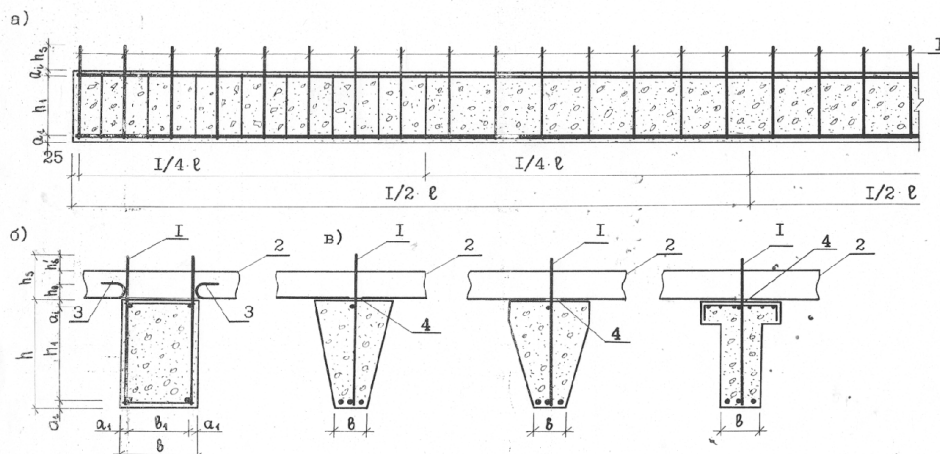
Конструкция сборного железобетонного прогона Б-2-1
